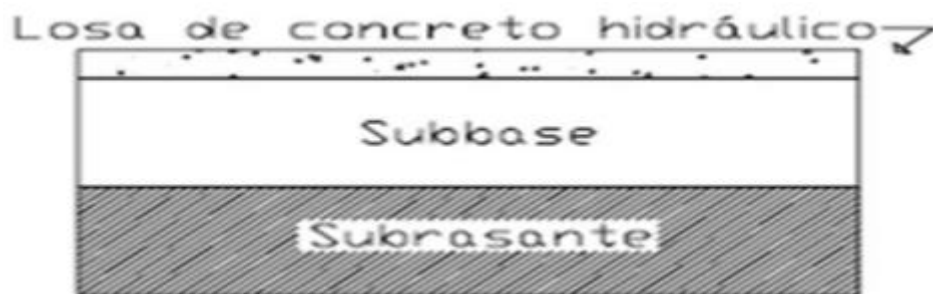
Carpeta de un pavimento rígido. Adaptado de SPG Constructora, por M. Centeno, 2019.
